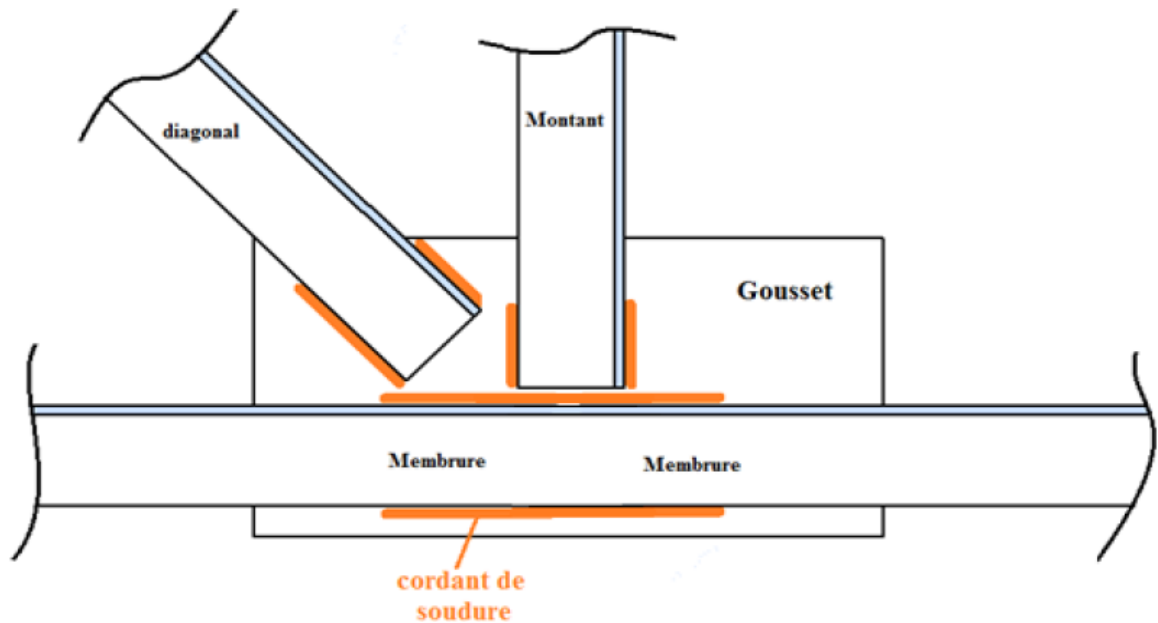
Détail assemblage Gousset- éléments de la ferme
